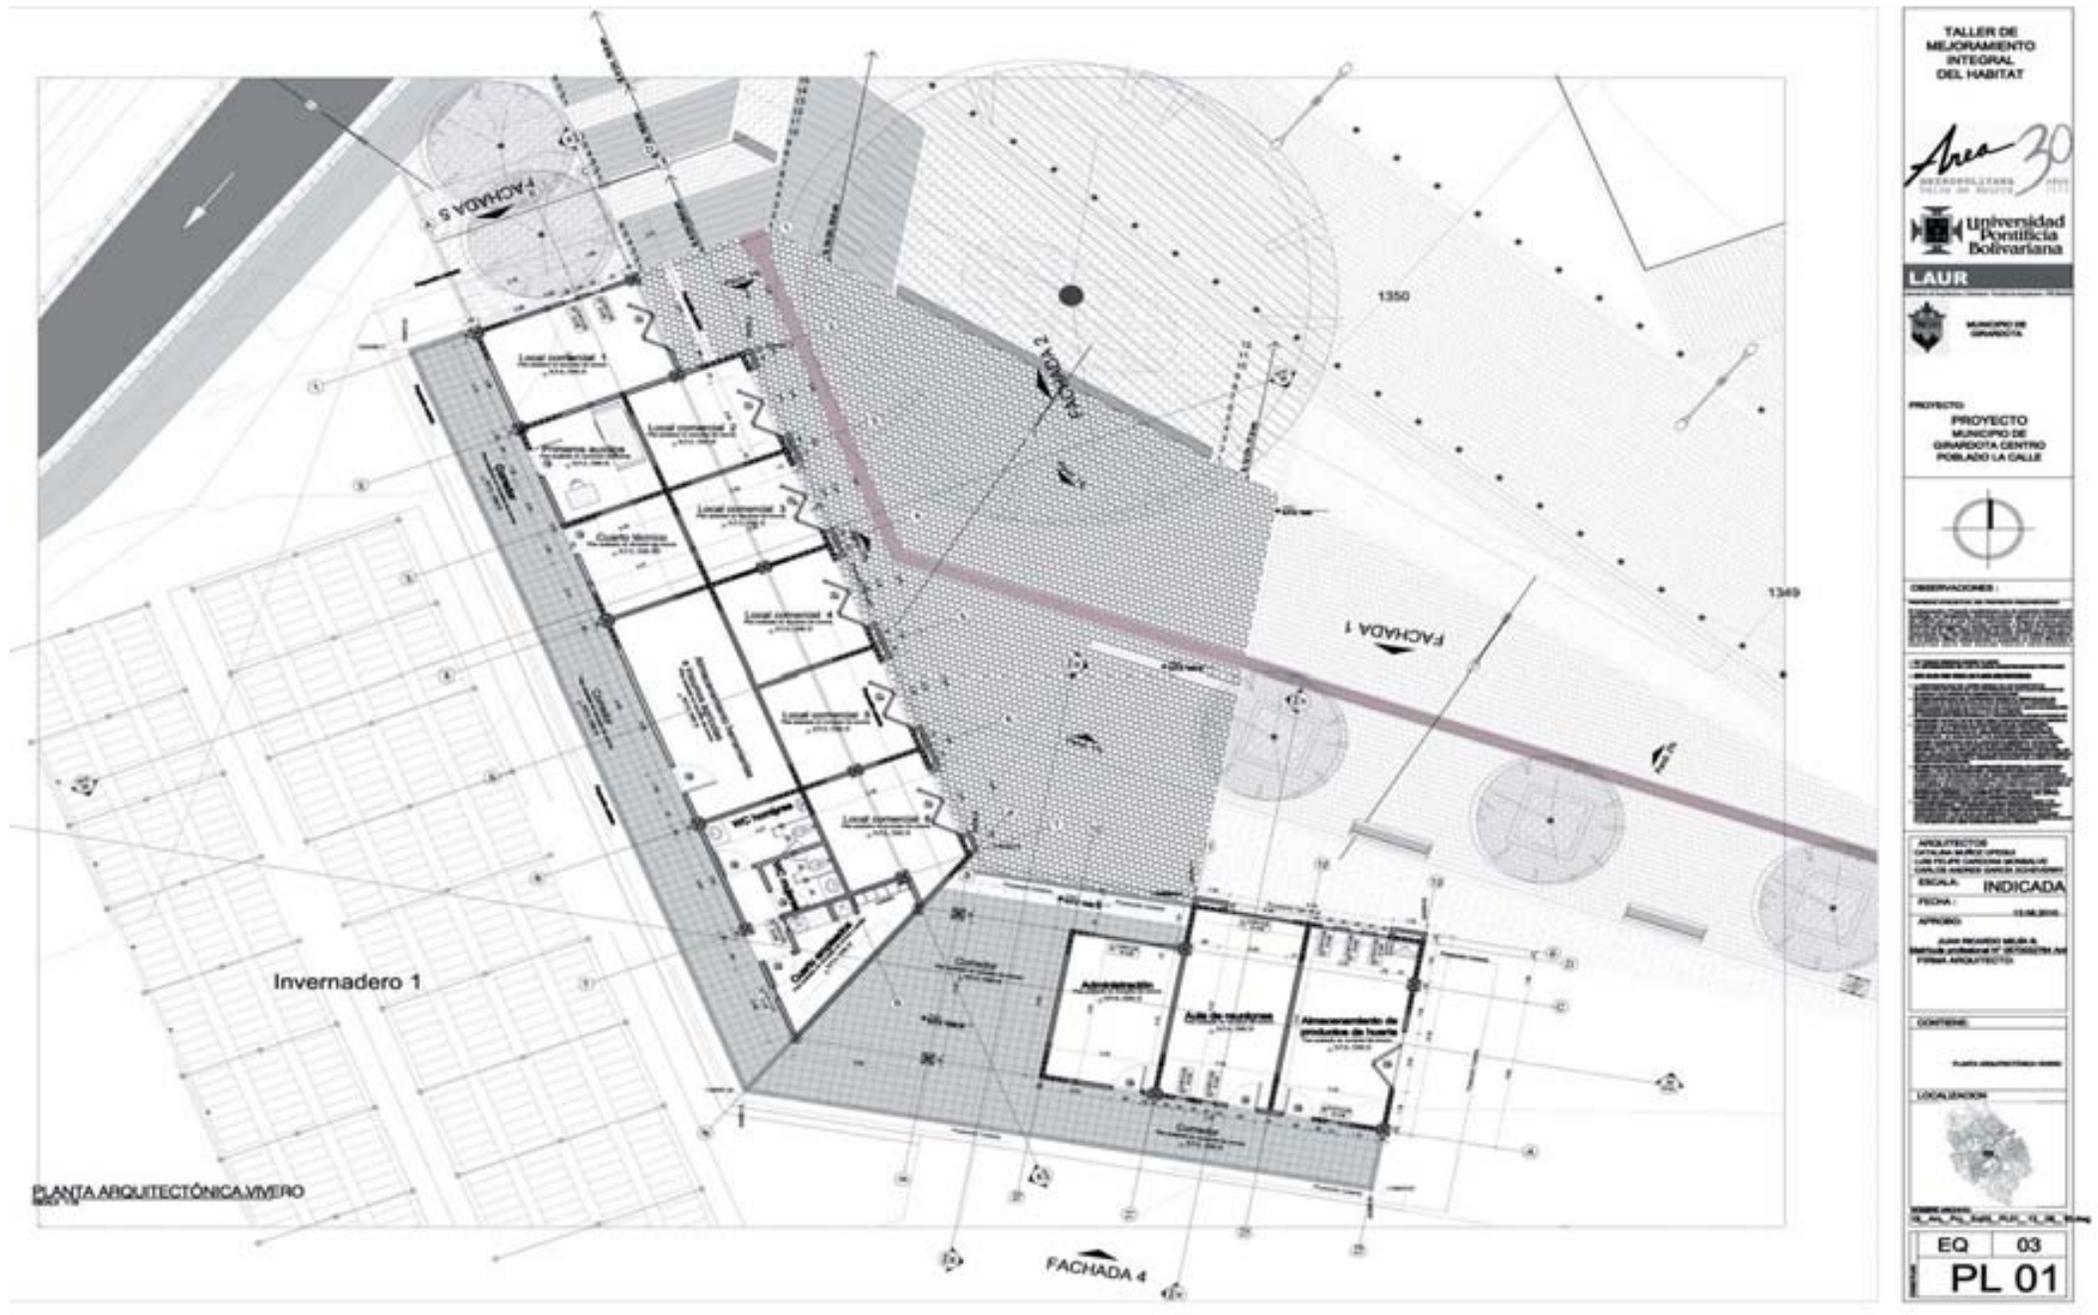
Planta general Proyecto de Equipamiento 03: Vivero
